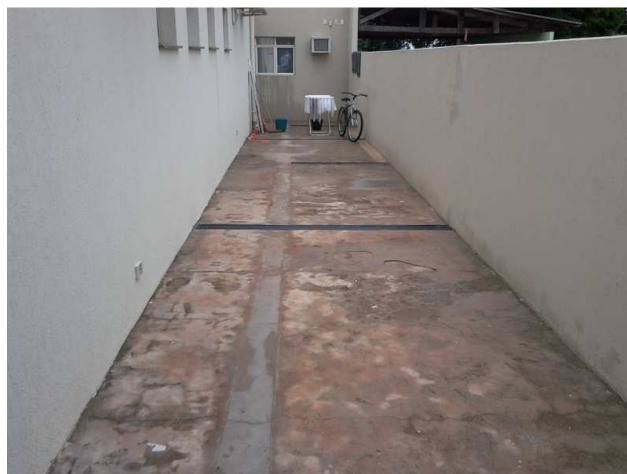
C: Piso cimentado sobre lastro de concreto, no refazimento da calçada onde foram executadas valas de assentamento da tubulação de drenagem pluvial
